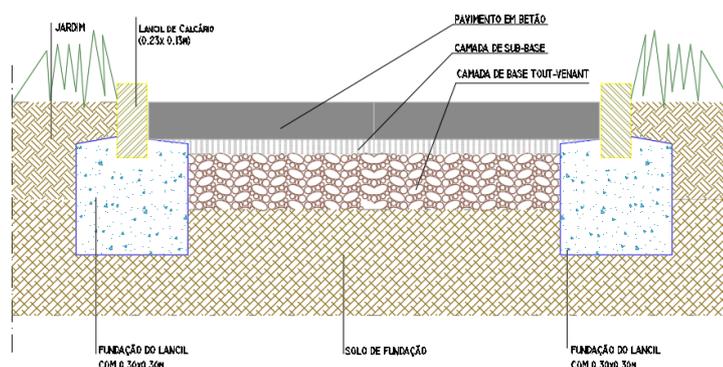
Exemplo esquemático de um pavimento exterior em betão
